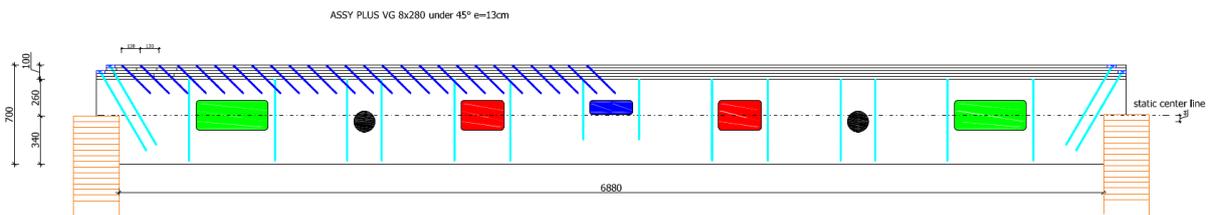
Deckenschnitt, Rippe mit TGA-Öffnungen (Quelle: ZÜBLIN Timber)
